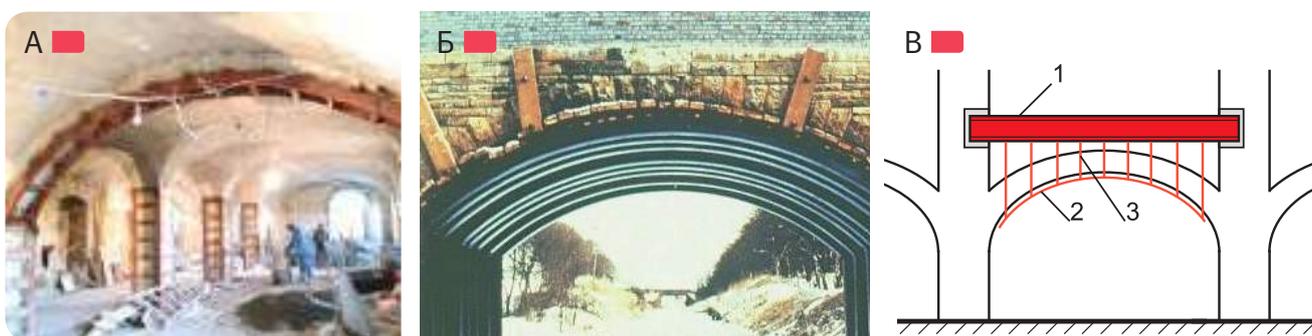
Усиление кирпичных сводчатых перекрытий: А – подведением стальных арочных элементов с трансляцией усилий на обоймы по колоннам здания 1795 г. на Контрактовой пл. в г. Киеве, 2015 г.; Б – подведение стальных арок при усилении моста в г. Airdrie, Шотландия; В – подвешивание свода к новым стальным балкам (1); 2 – сетка; 3 – тяжи
